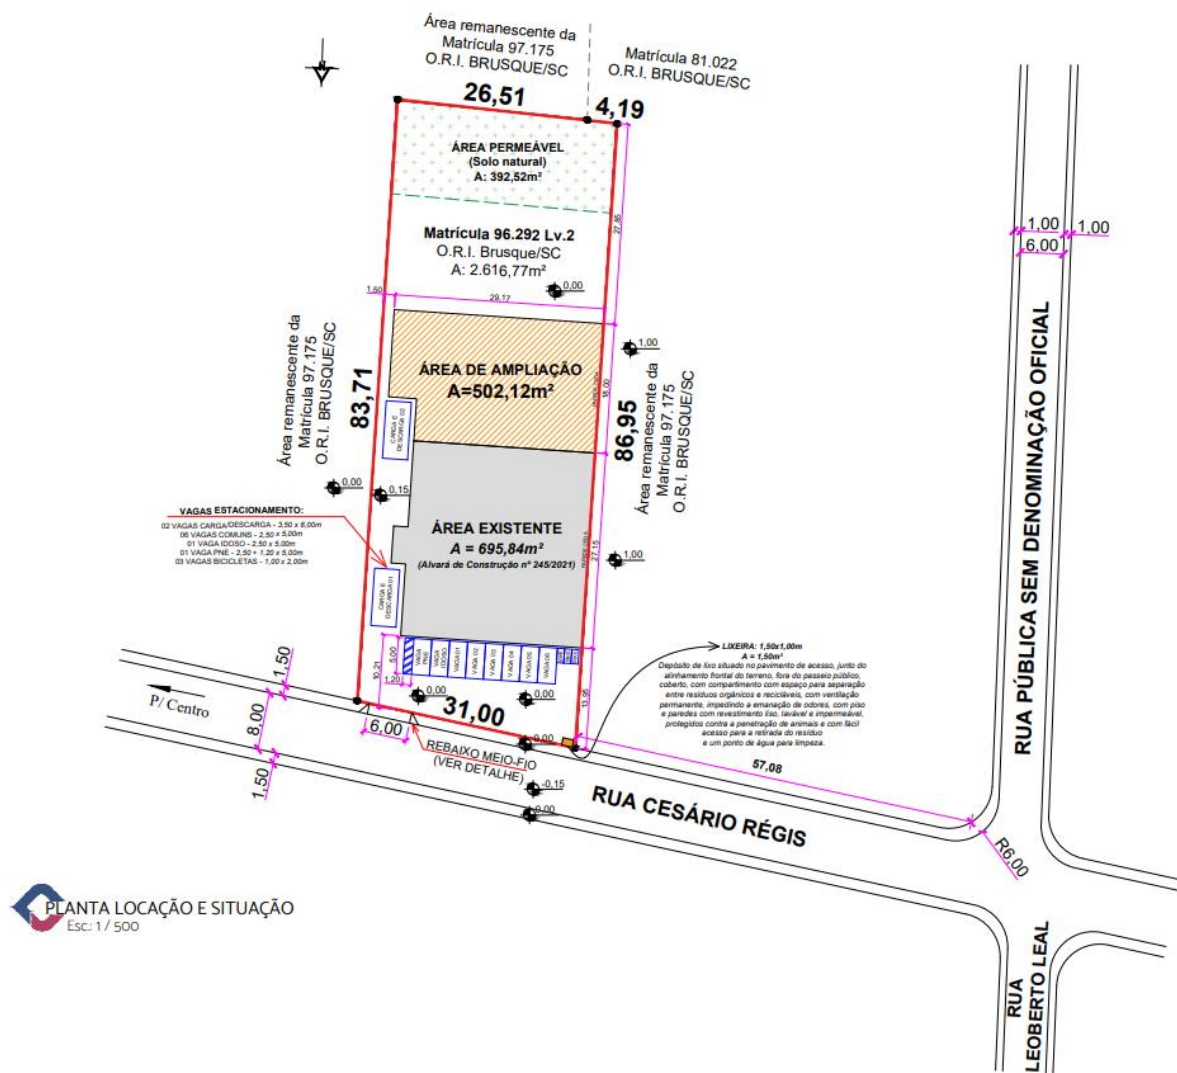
Planta de localização do empreendimento com layout das vagas de estacionamento.
